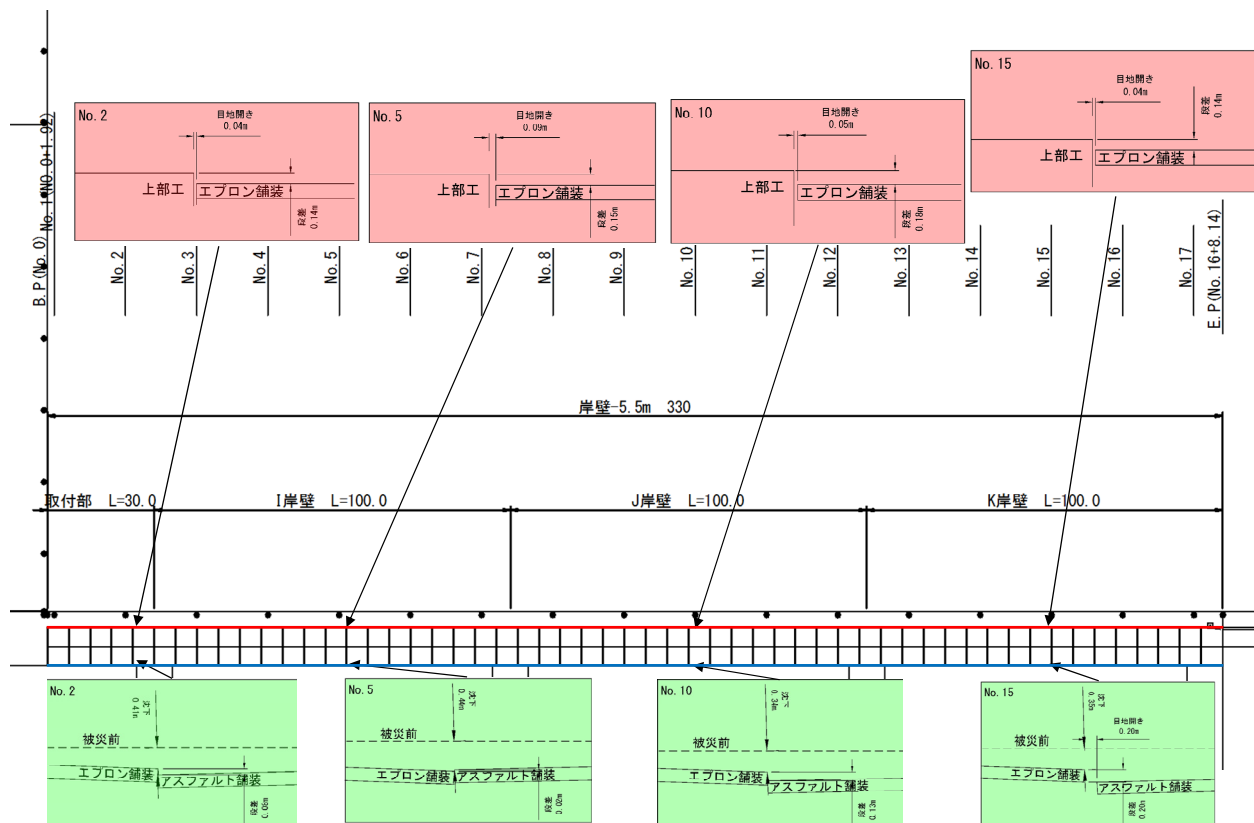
No.18 常陸那珂港区\_北ふ頭地区岸壁 (-5.5m) I,J,K の平面図 (被災後)
